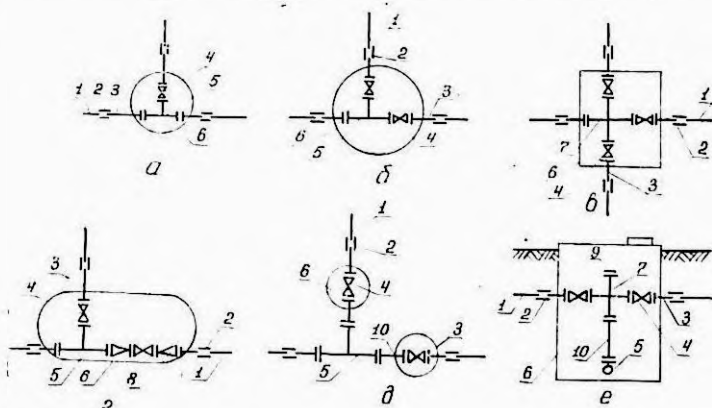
Схема размещения колодцев на трубопроводах с арматурой: 1 — трубопровод; 2 — соединение труб (на асбестоцементных — муфтой; на стальных — фланцами); 3 — патрубок; 4 — задвижка; 5 — тройник; 6 — колодец; 7 — крестовина; 8 — переход; 9 — заглушка; 10 — стальная труба.
